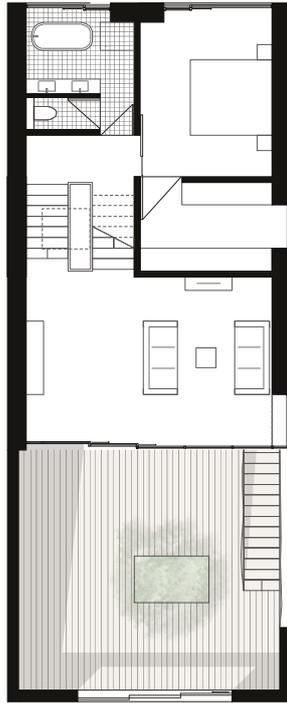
Grundrisse: OGs. Typ 1 Zone II. M 1:200
